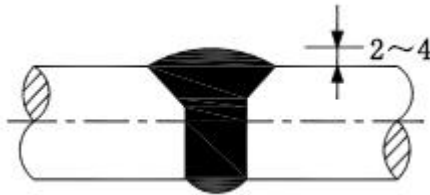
钢筋窄间隙焊接头
